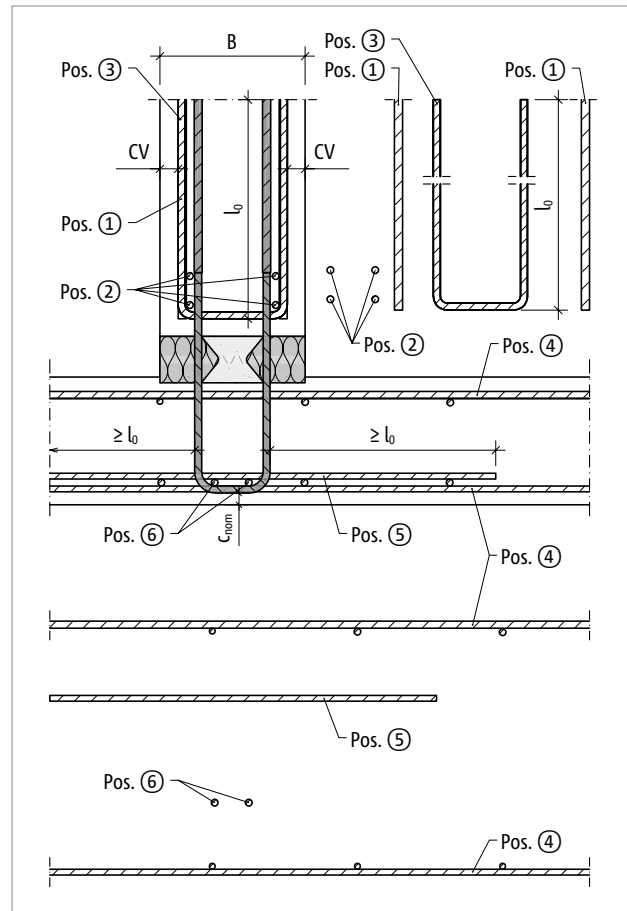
Schöck Scconnex® Typ W-NT-BW: Bauseitige Bewehrung bei Zugkraftverankerung in der Decke mit Zulagebewehrung Pos. 5
